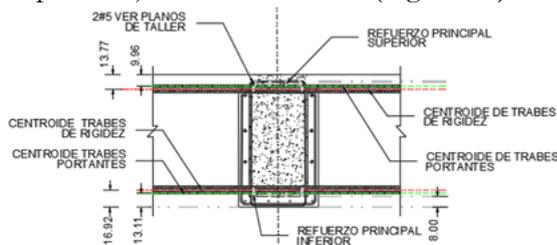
Canto efectivo en el diseño de refuerzo en vigas prefabricadas.
